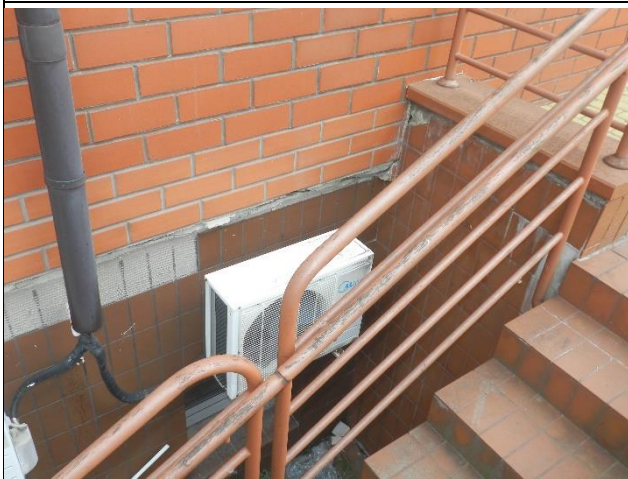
Widok uszkodzonych płytek elewacyjnych przy nadprożach okiennych.
